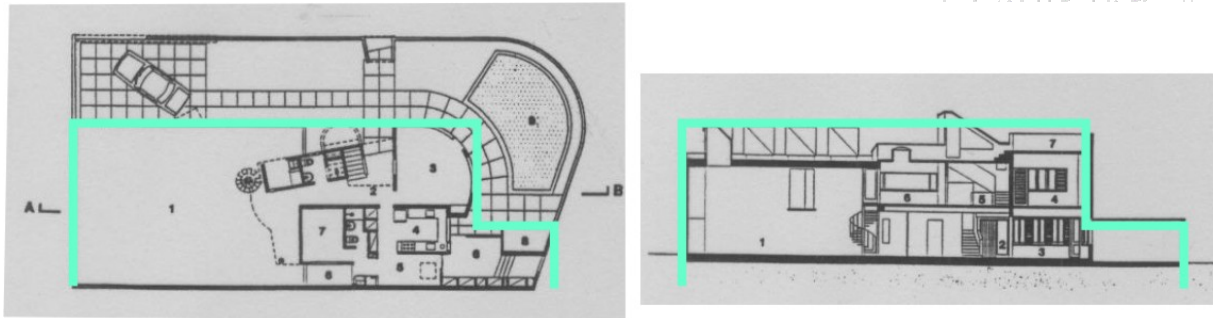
Planta do Primeiro Piso e Corte Longitudinal: Relação Planta e Corte
